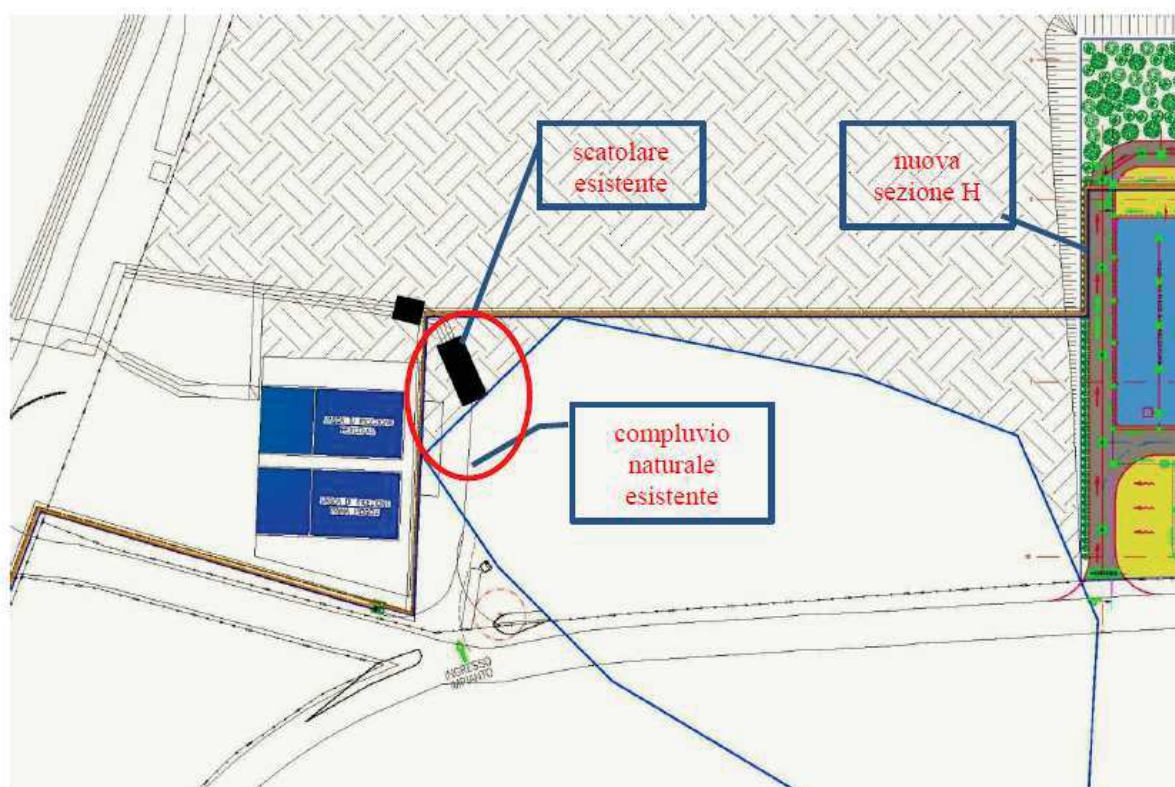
Ubicazione planimetrica del tratto di condotta che scarica in compluvio naturale
